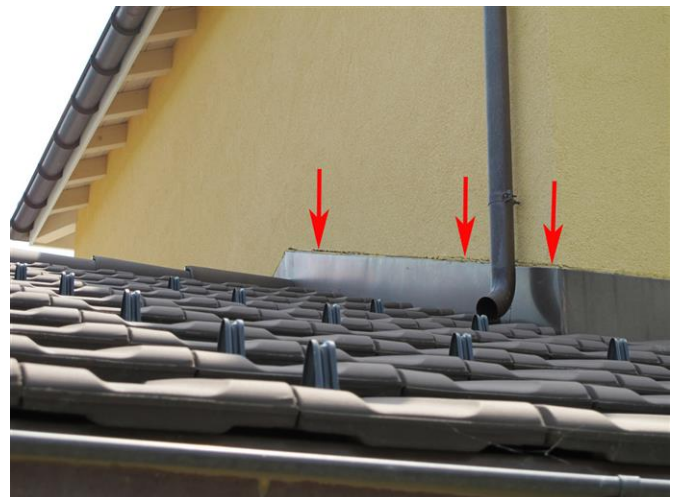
IMG_0021q.jpg / Aussen Fassaden / Ost
